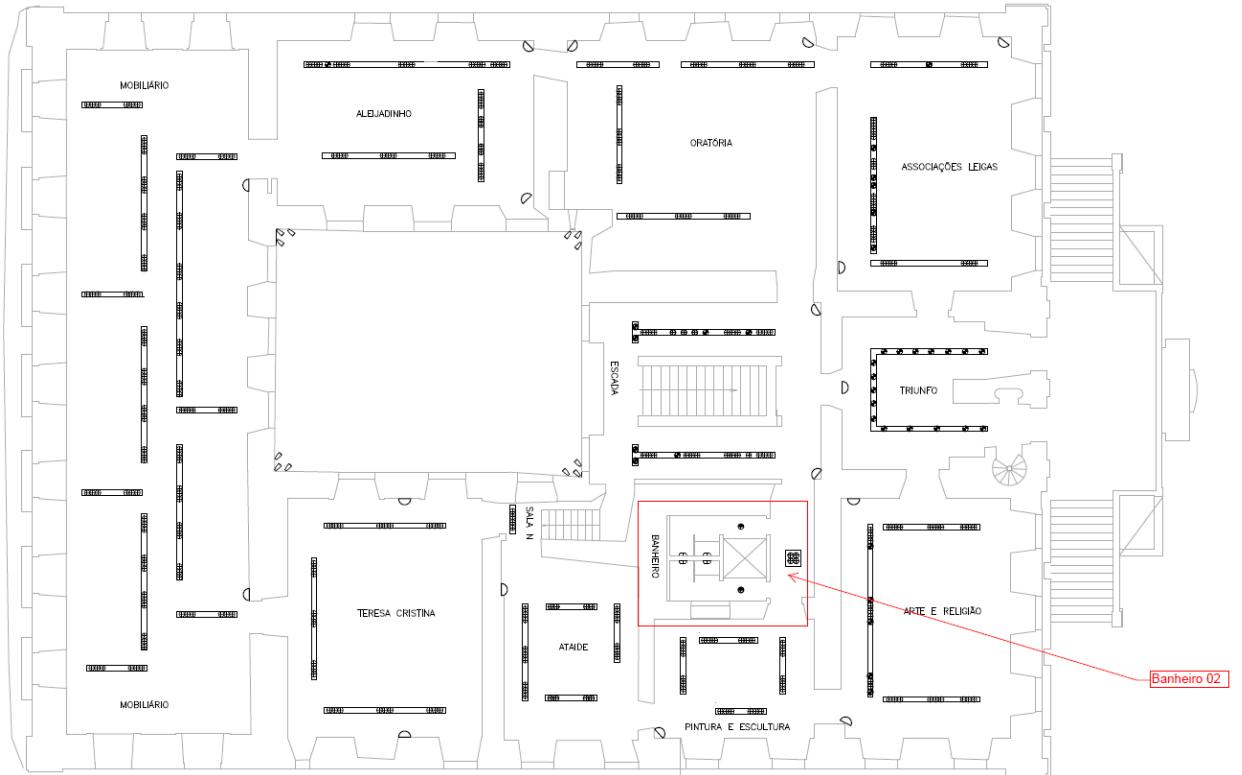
Planta Edifício Sede – Piso 02 - Localização Banheiro
